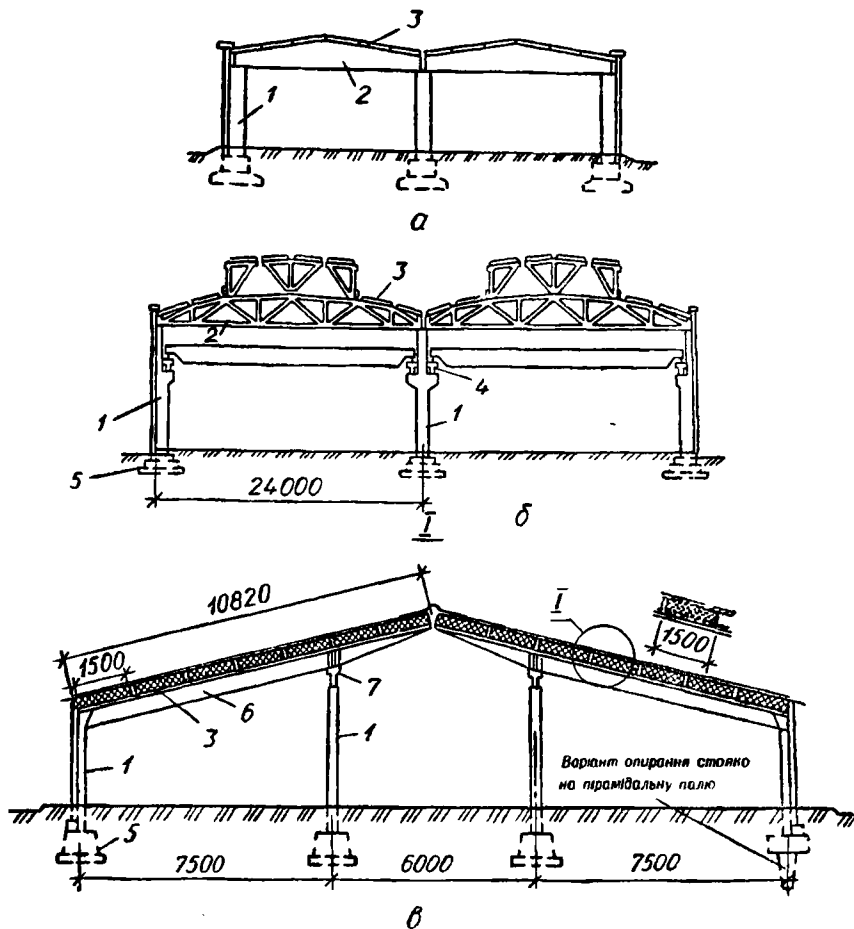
Схеми поперечних рам каркасів одноповерхових будівель з типовими залізобетонними конструкціями:
